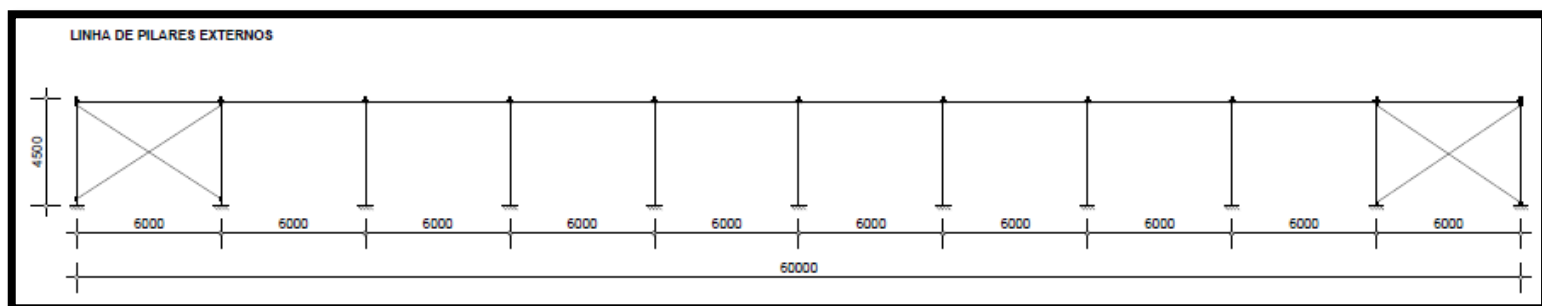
Elevação longitudinal dos pilares externos do *Compost Barn
